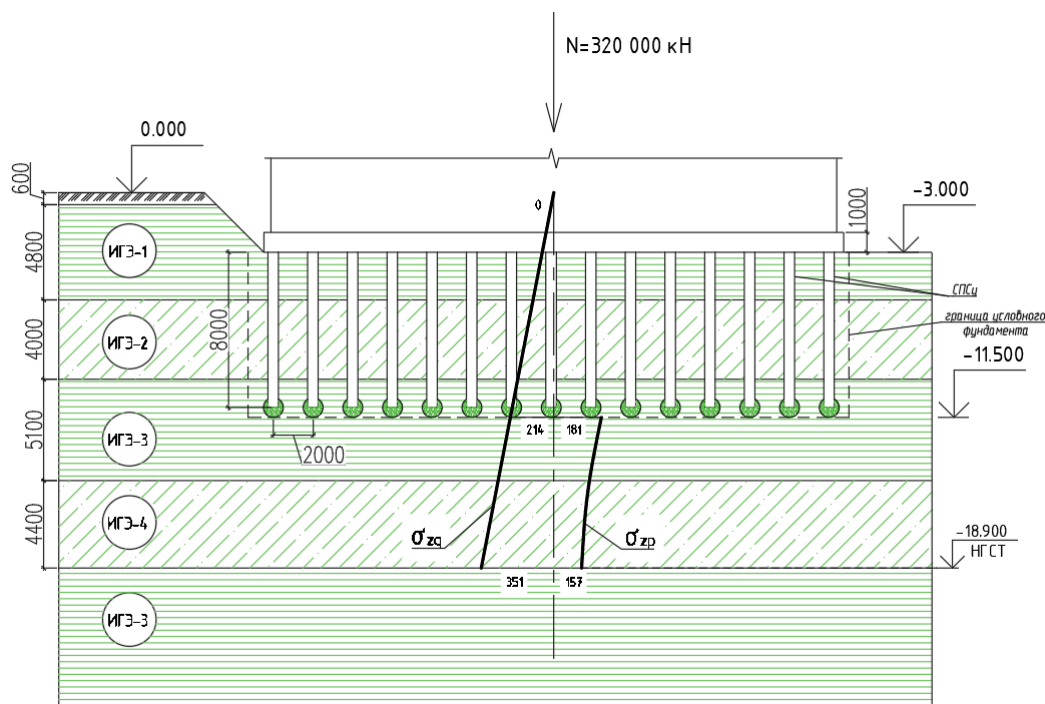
Расчетная схема фундамента из свай в пробитых в скважинах с уширением
